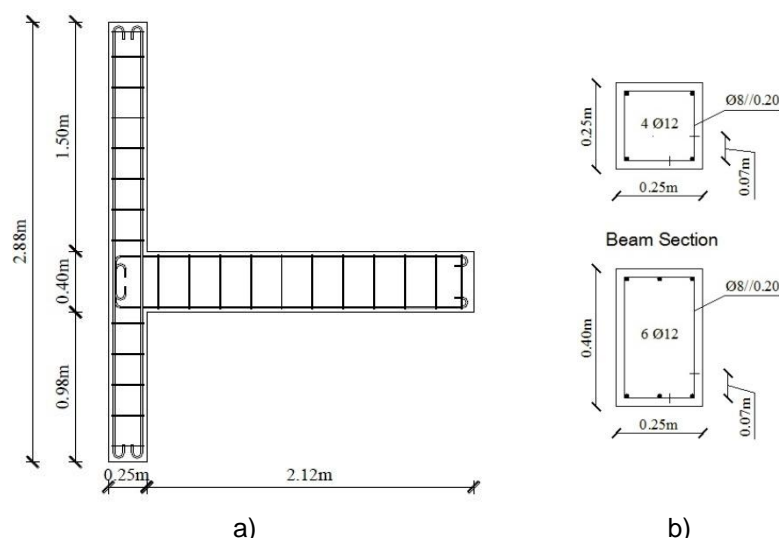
Armadura do provete TPA: a) disposição geral; b) detalhes das secções;
